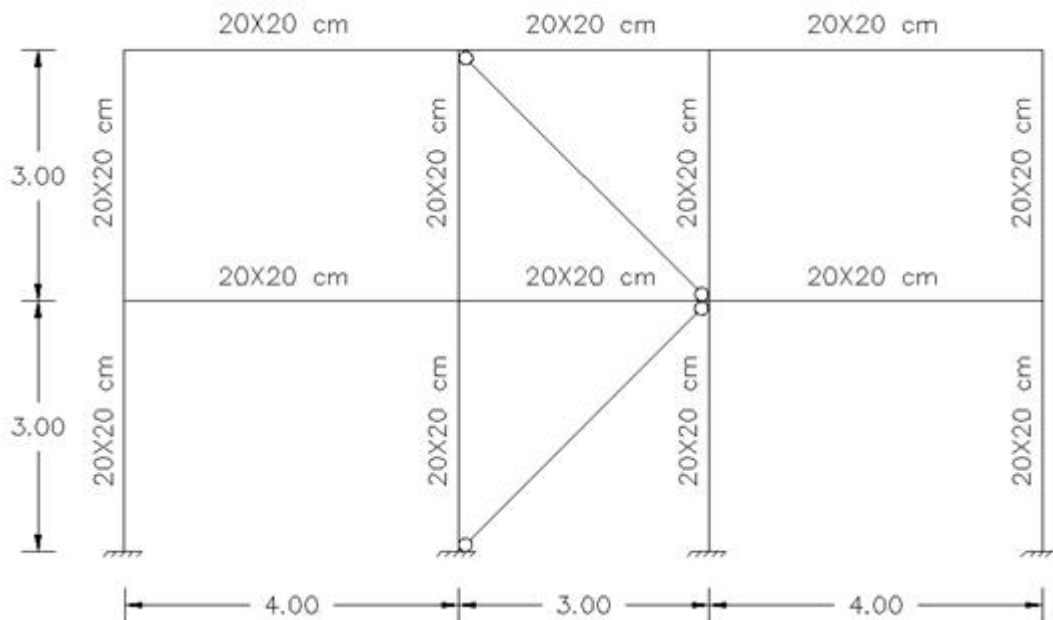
Pórtico de Hormigón con diagonales de acero
